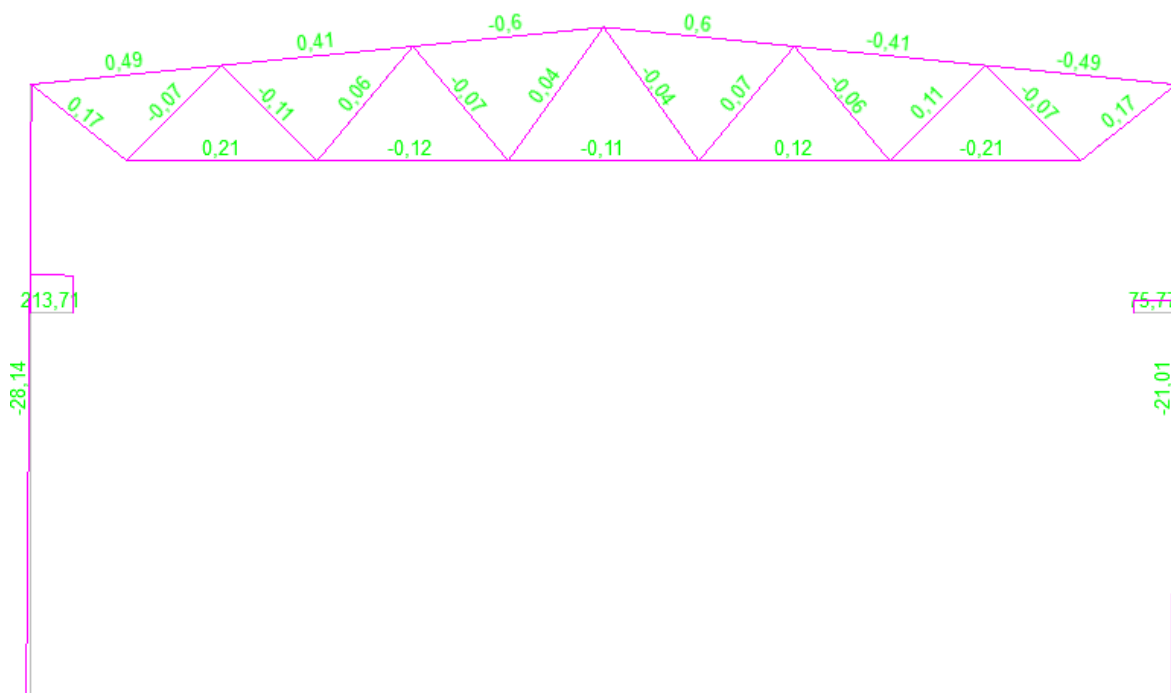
Эпюра максимальных поперечных сил  $Q$  (кН) от расчетного сочетания нагрузок в элементах поперечной рамы
